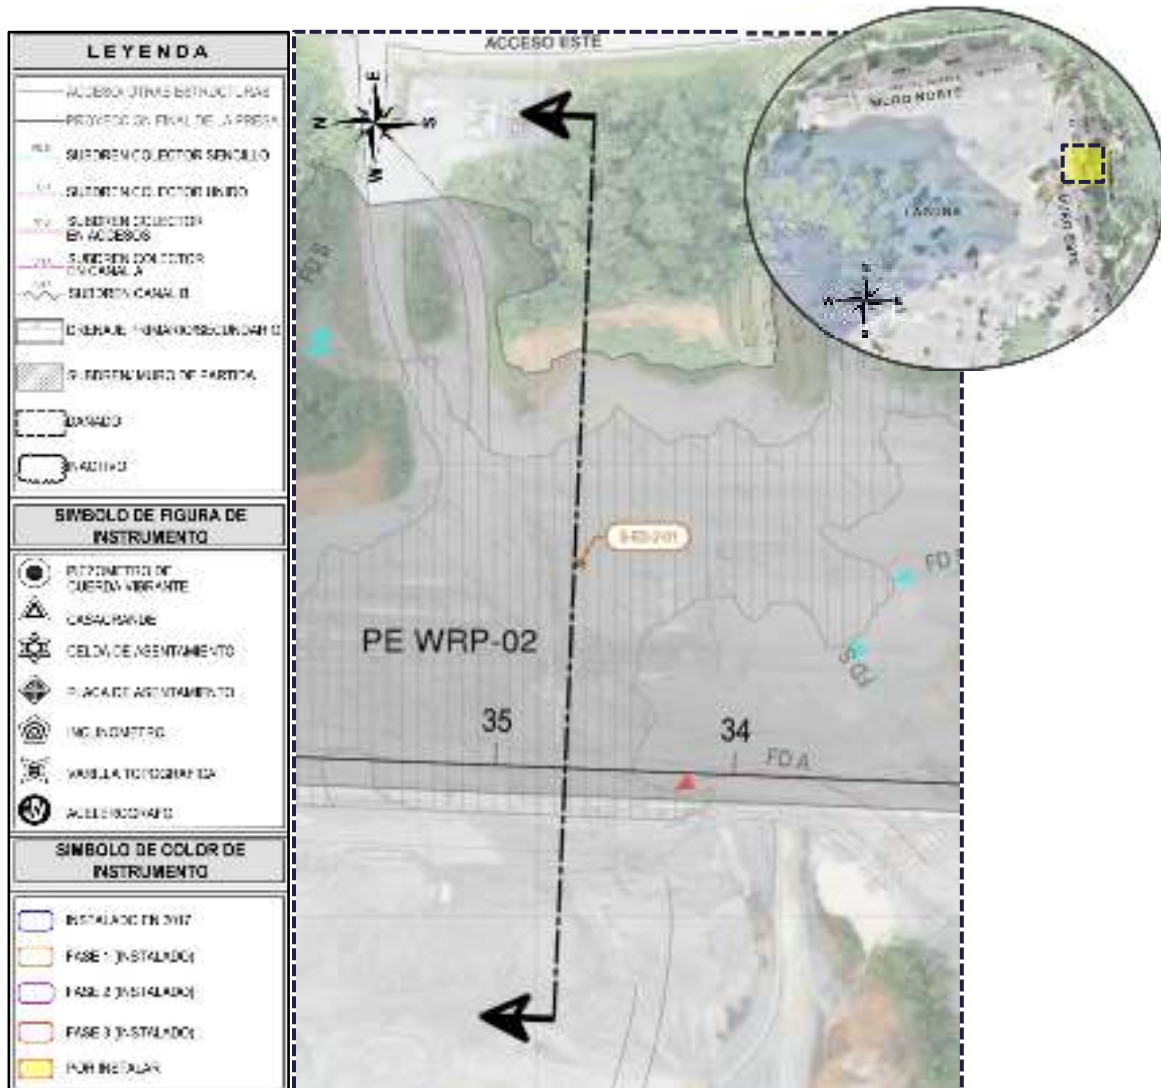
Vista de Planta en el Muro Este WRP2 con las Celdas de Asentamiento
